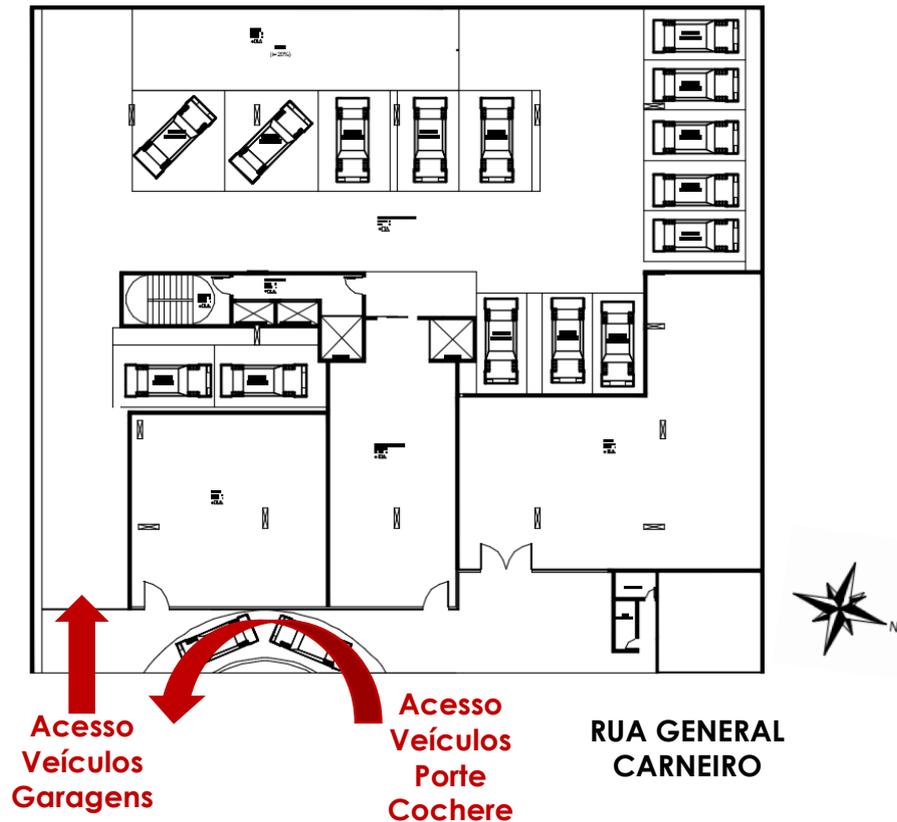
Planta Baixa Pavimento Térreo - Acesso de veículos
